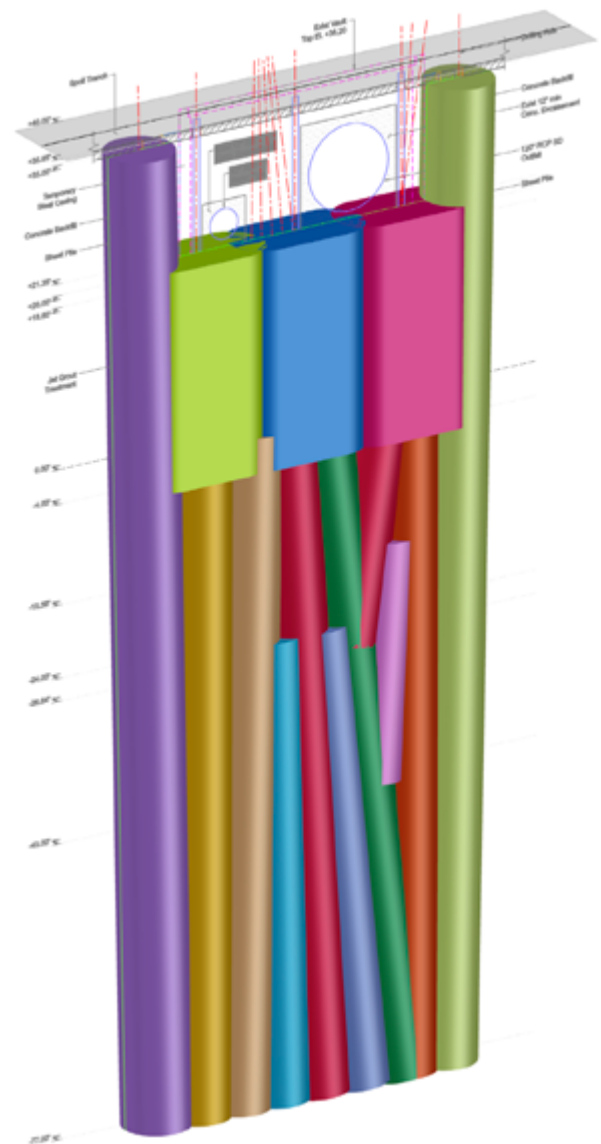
| Pioneer Reservoir Outfall Crossing S1 esecuzione pannelli
